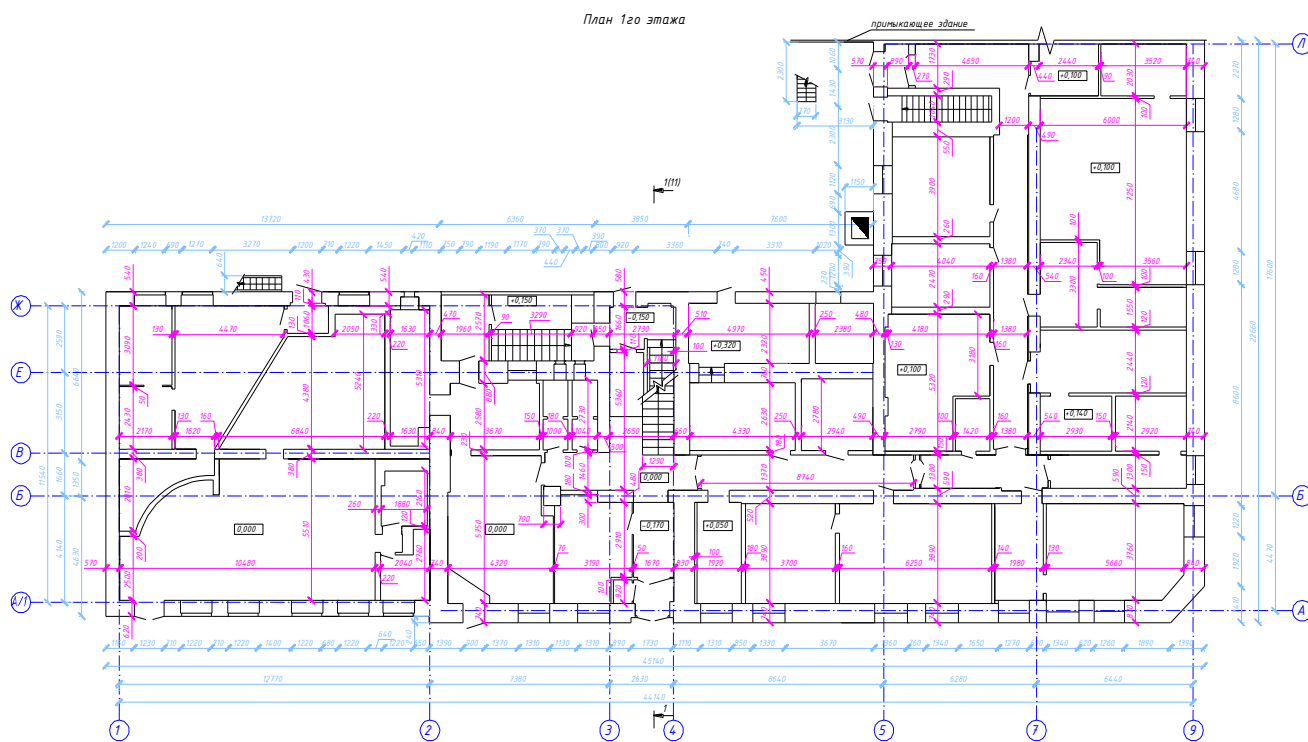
План 1-го этажа здания в г. Ростов-на-Дону
